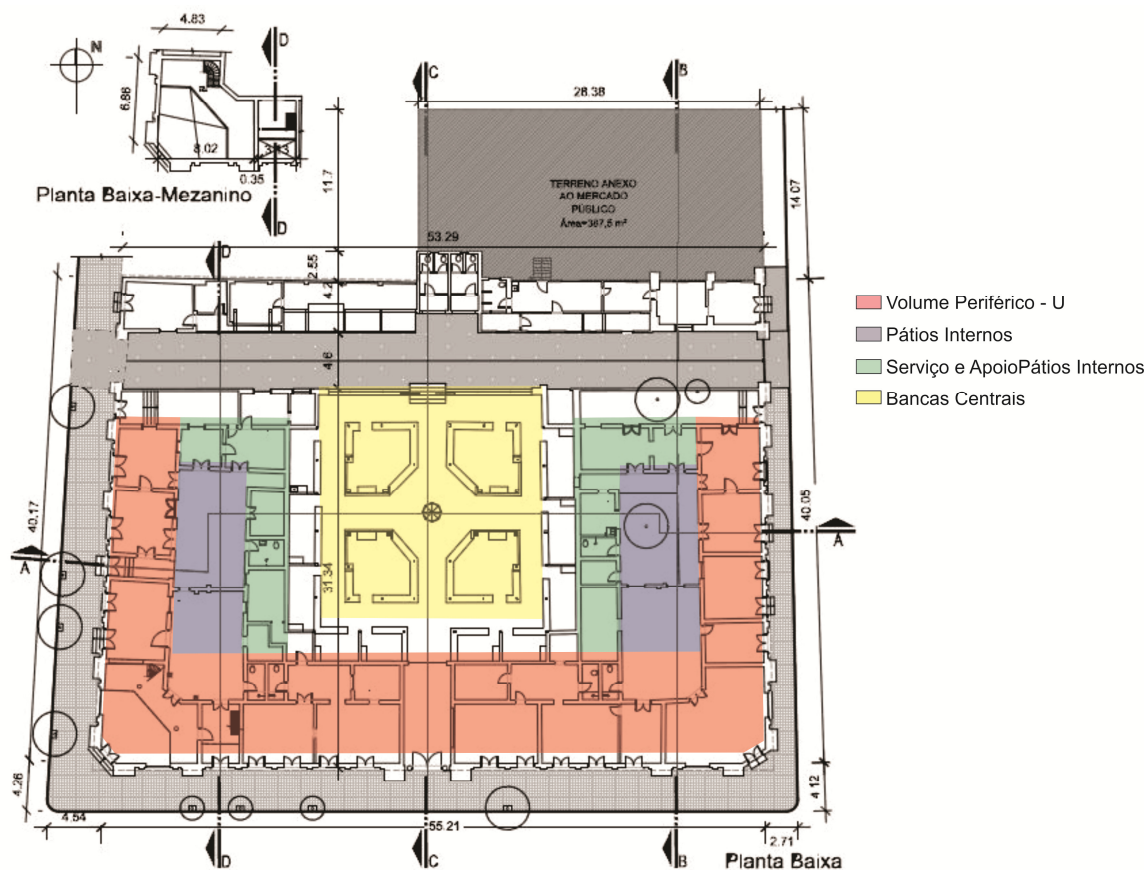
Planta Baixa do Mercado Público de Itaquí com zoneamento.
